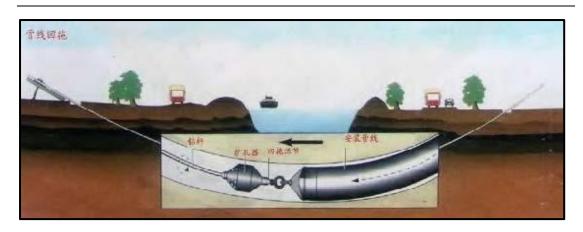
定向钻穿越施工管线回拖过程断面示意图
